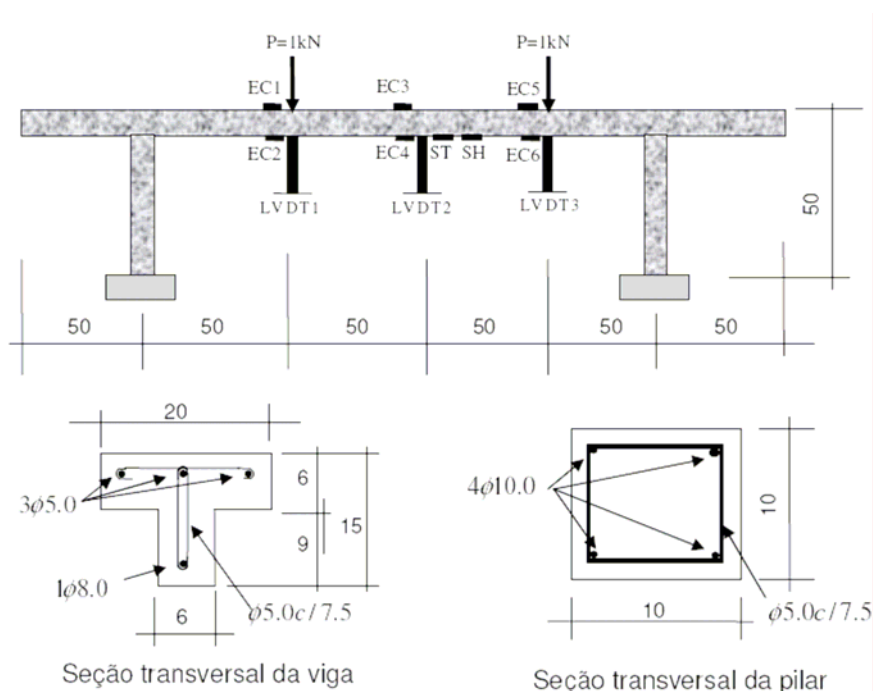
Protótipo de micro concreto instrumentado para ensaio de carregamento de longa duração para a determinação da fluência e retração
